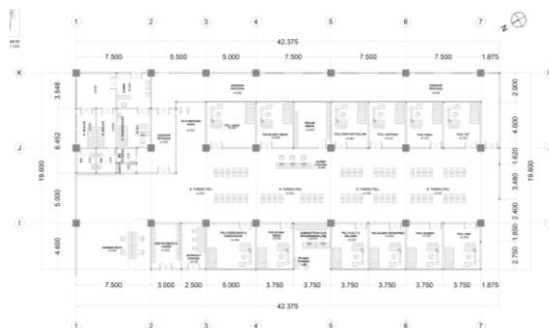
Blokplan Lantai 1 Rumah Sakit Dharma Husada
